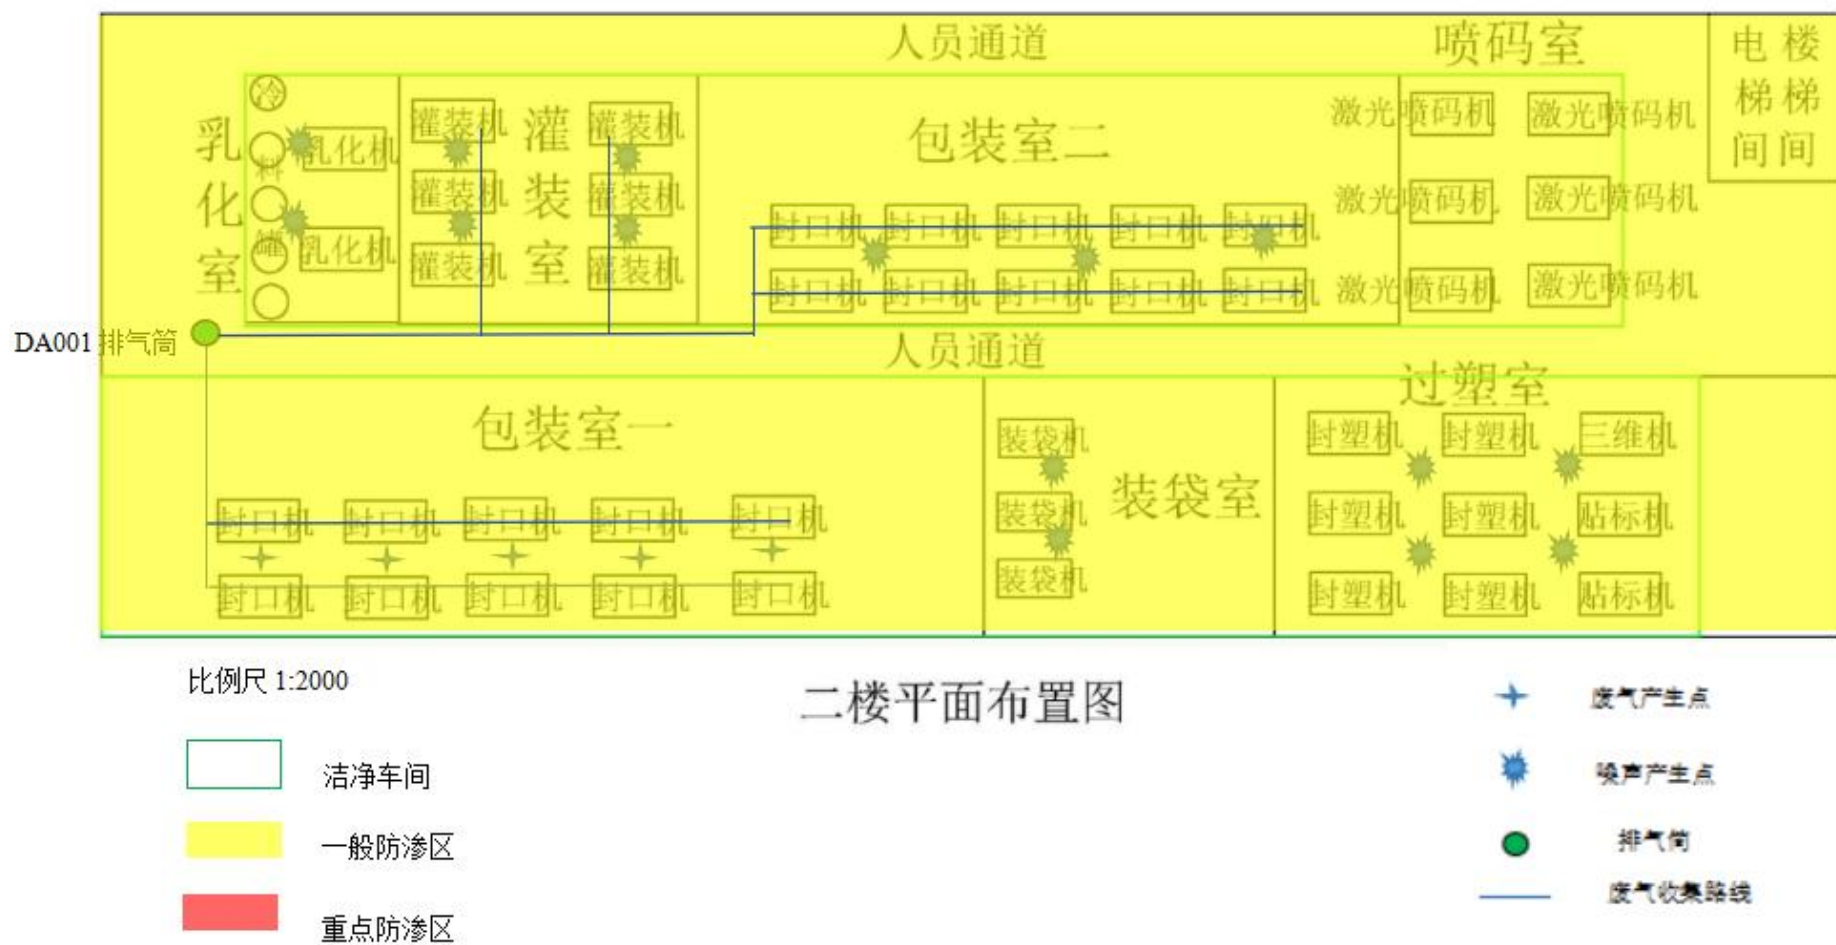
环评-厂区生产车间二楼平面布置图（2）
